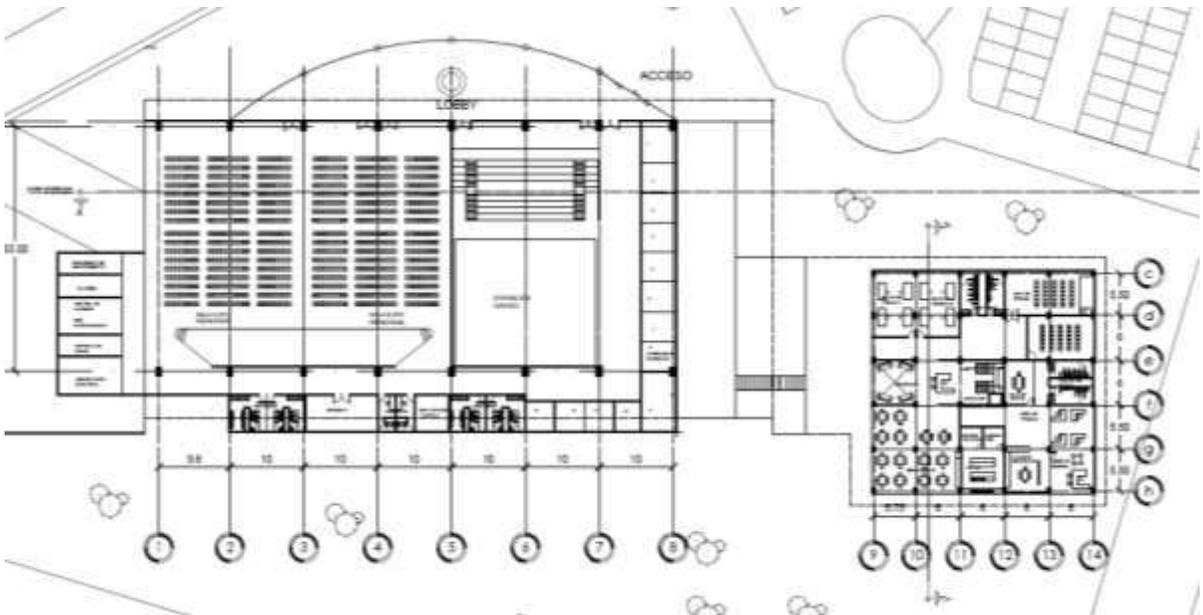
de planta de primera idea de Centro de Convenciones y Negocios
